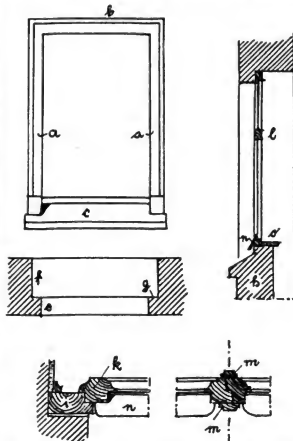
Fenster. — Oben: Ansicht, Schnitt, Grundriß; unten: waagrechter Schnitt durch Holzteile.
